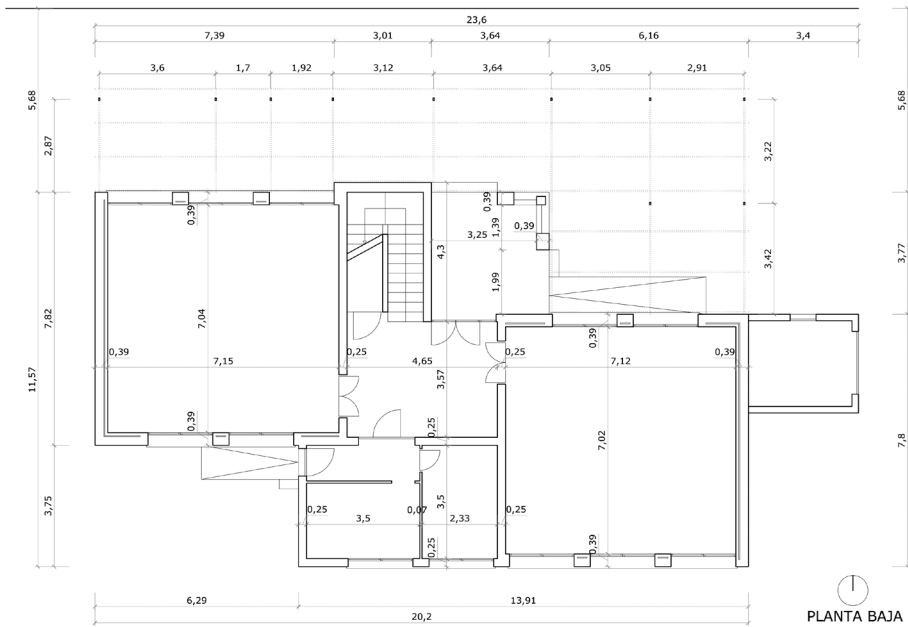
Planta baja. C.E.I.P. Los Llanos, Almonte (Huelva).
